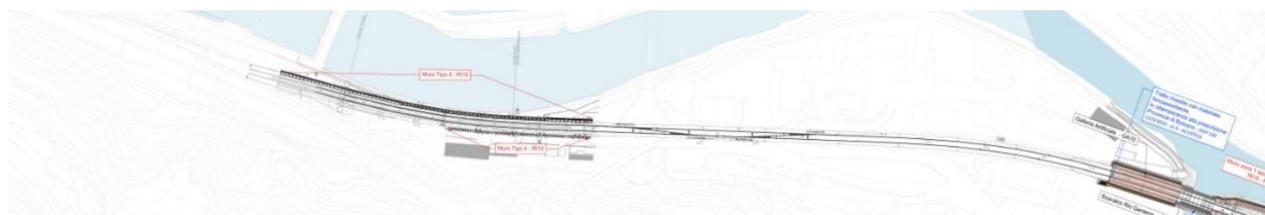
Interventi a Ponte Gardena: planimetria generale tratto SUD
